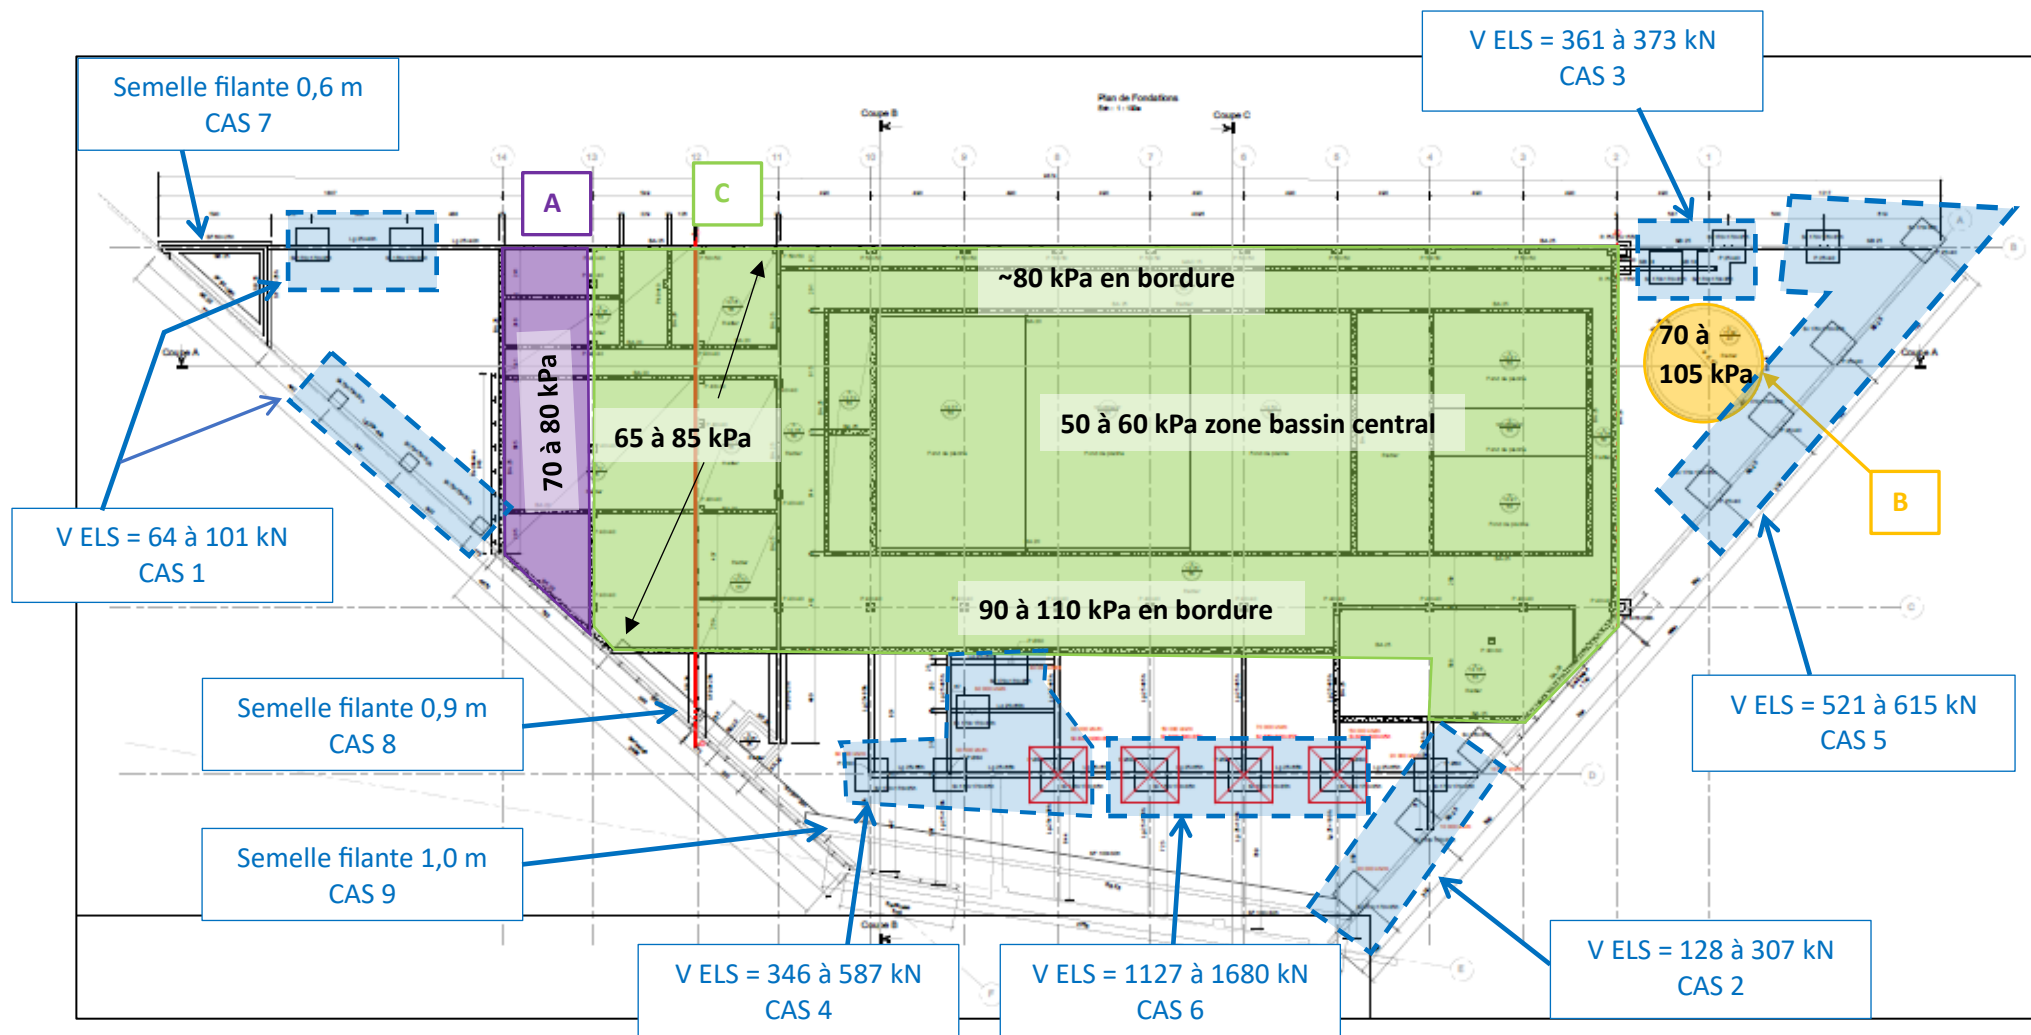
Synthèse DDC du 14/04/2025 indice A sur plan de fondations
